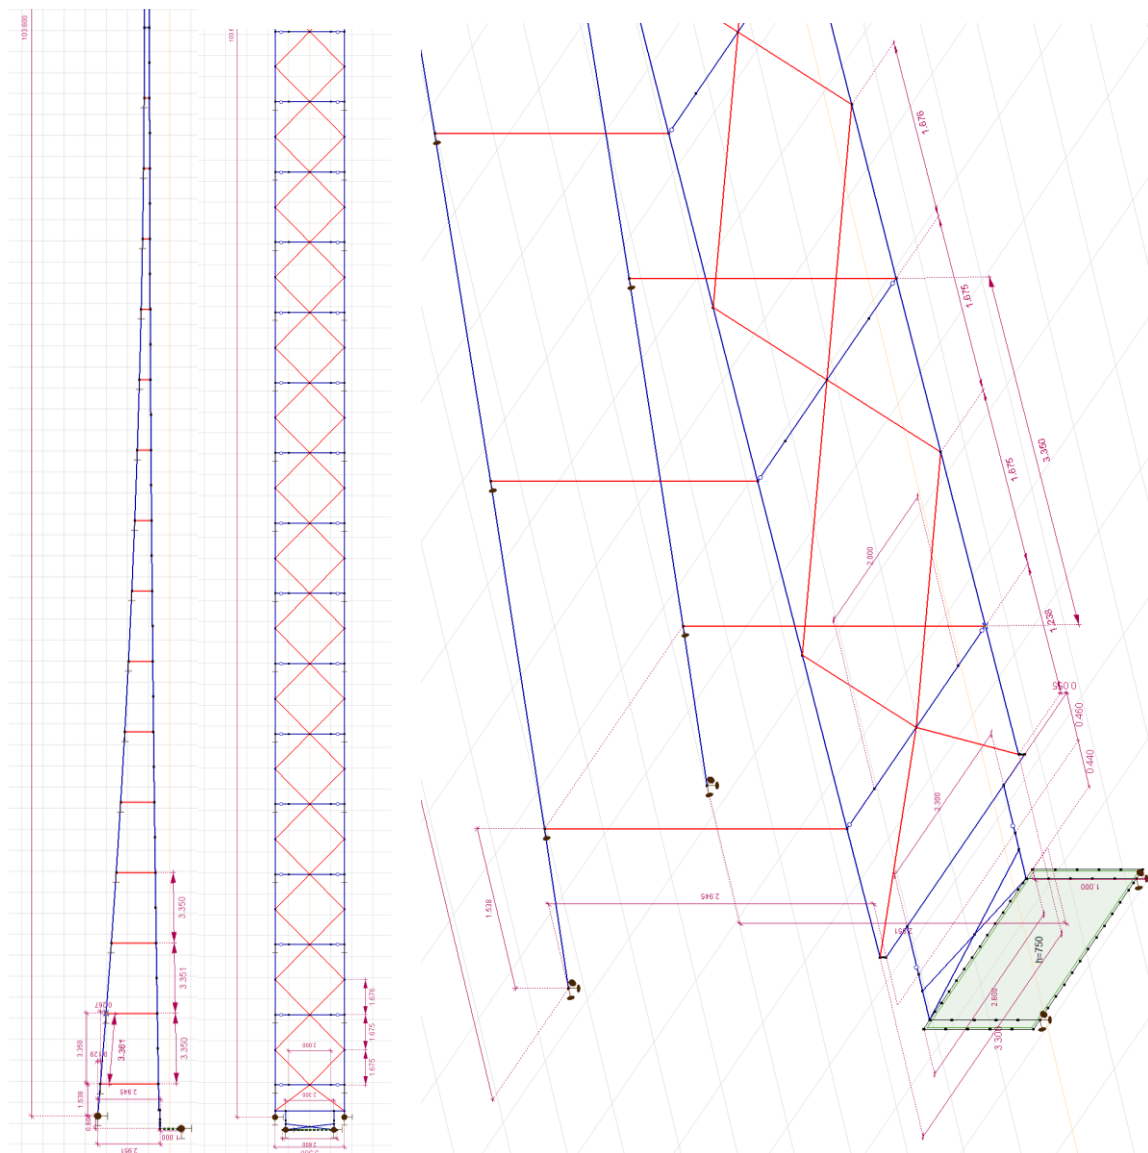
Ansicht und Grundriss einer Brückenhälfte (infolge lesbarkeit, der Aufbau im Modell ist symmetrisch), Isometrie der Auflager/Pendelwandsituation
